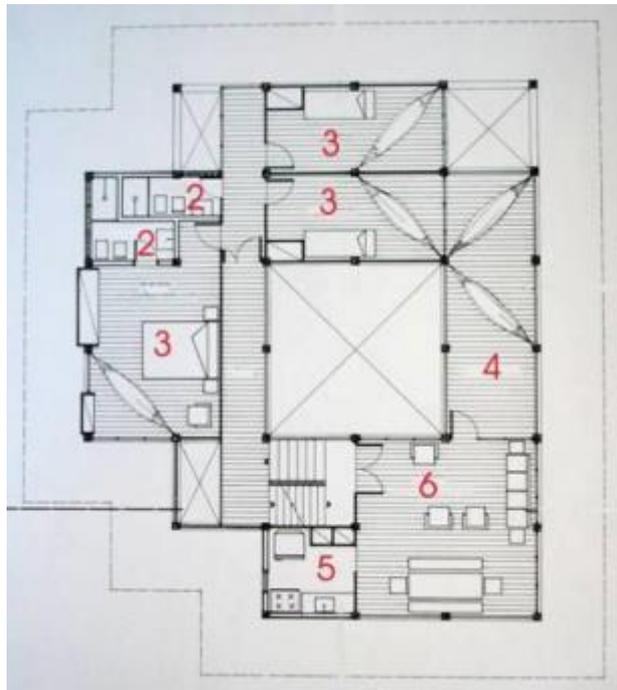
Planta do Segundo pavimento da residência Robert Schuster, projetada por Severiano Porto. Fonte: Archdaily Brasil.
